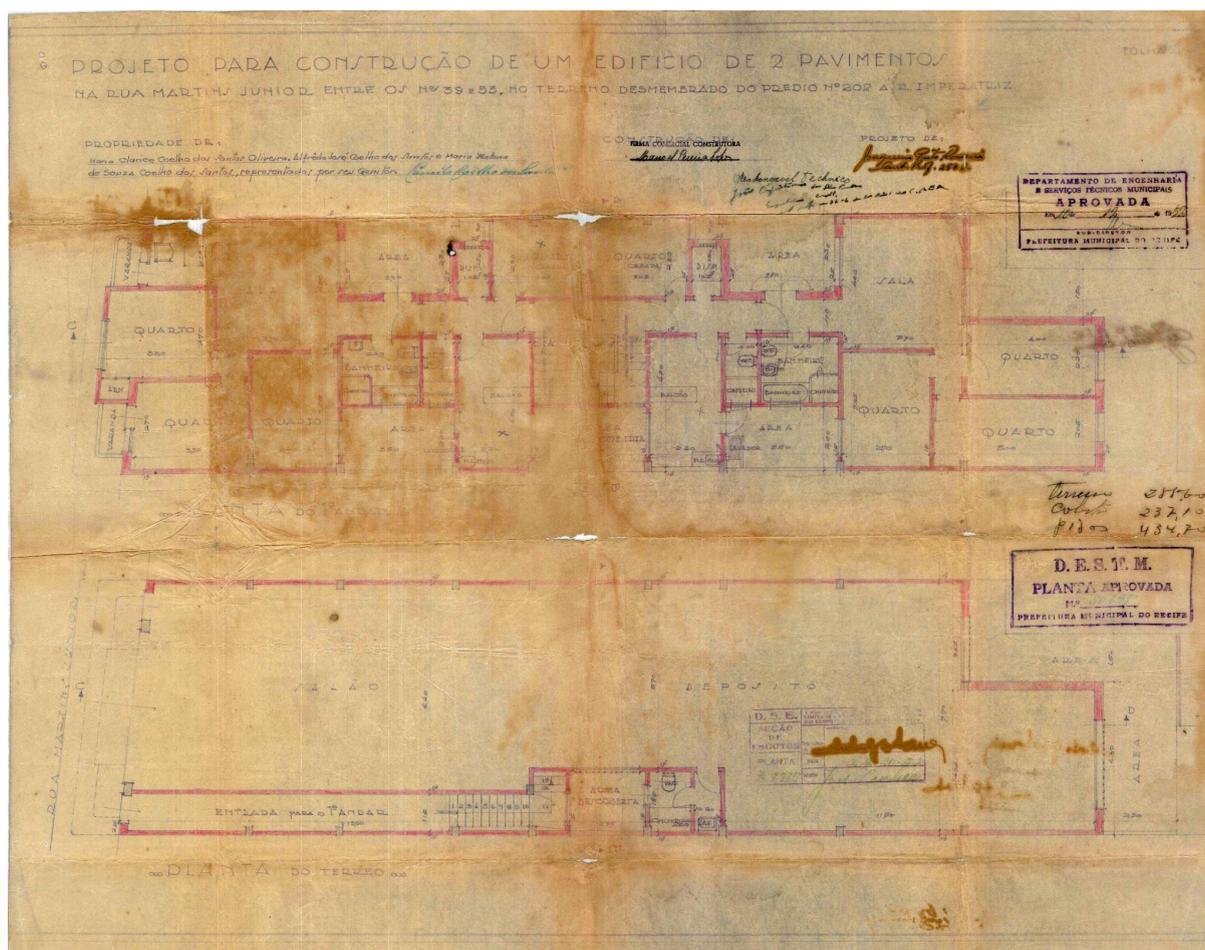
Planta baixa do térreo com loja e primeiro pavimento com dois apartamentos e acesso independente.
